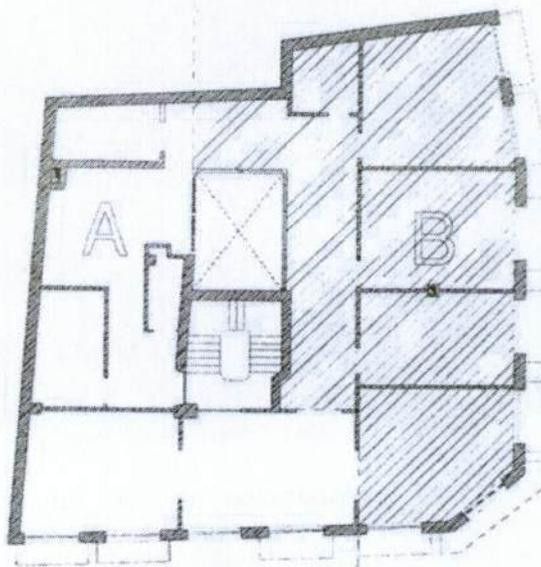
esquema de planta en el que se distinguen las dos tipologías estructurales.
